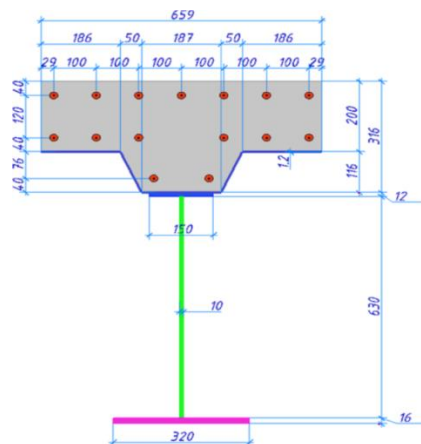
Поперечний переріз стале залізобетонного перекриття
